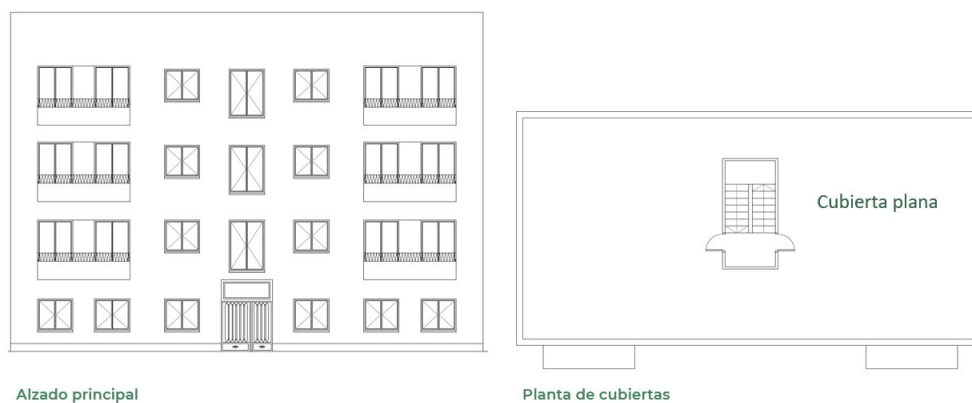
Alzado principal y planta de cubiertas del edificio tipo
